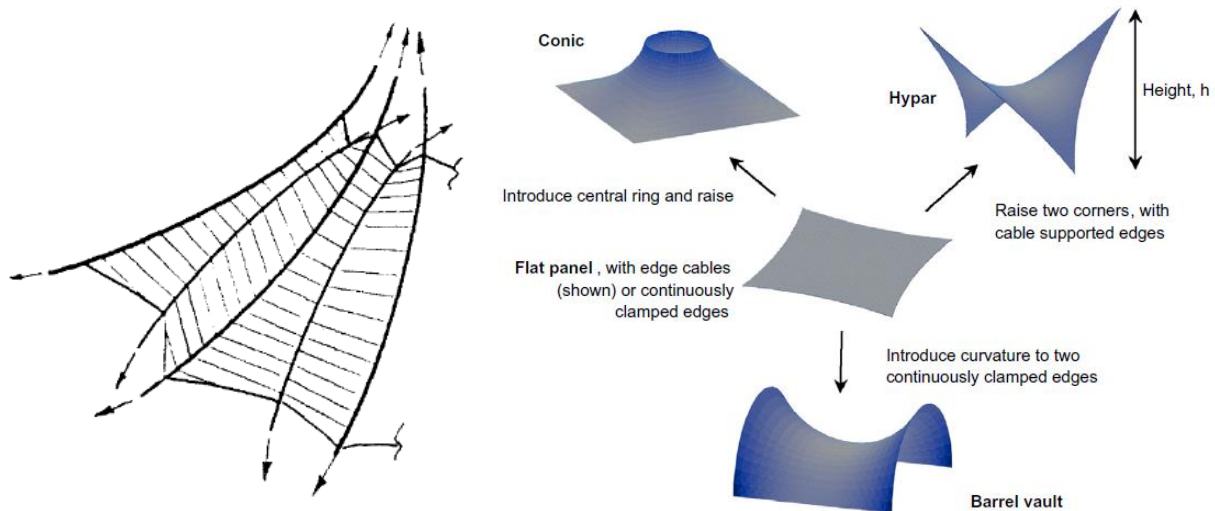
Krachtenafdracht in elementen van een overkapping.
